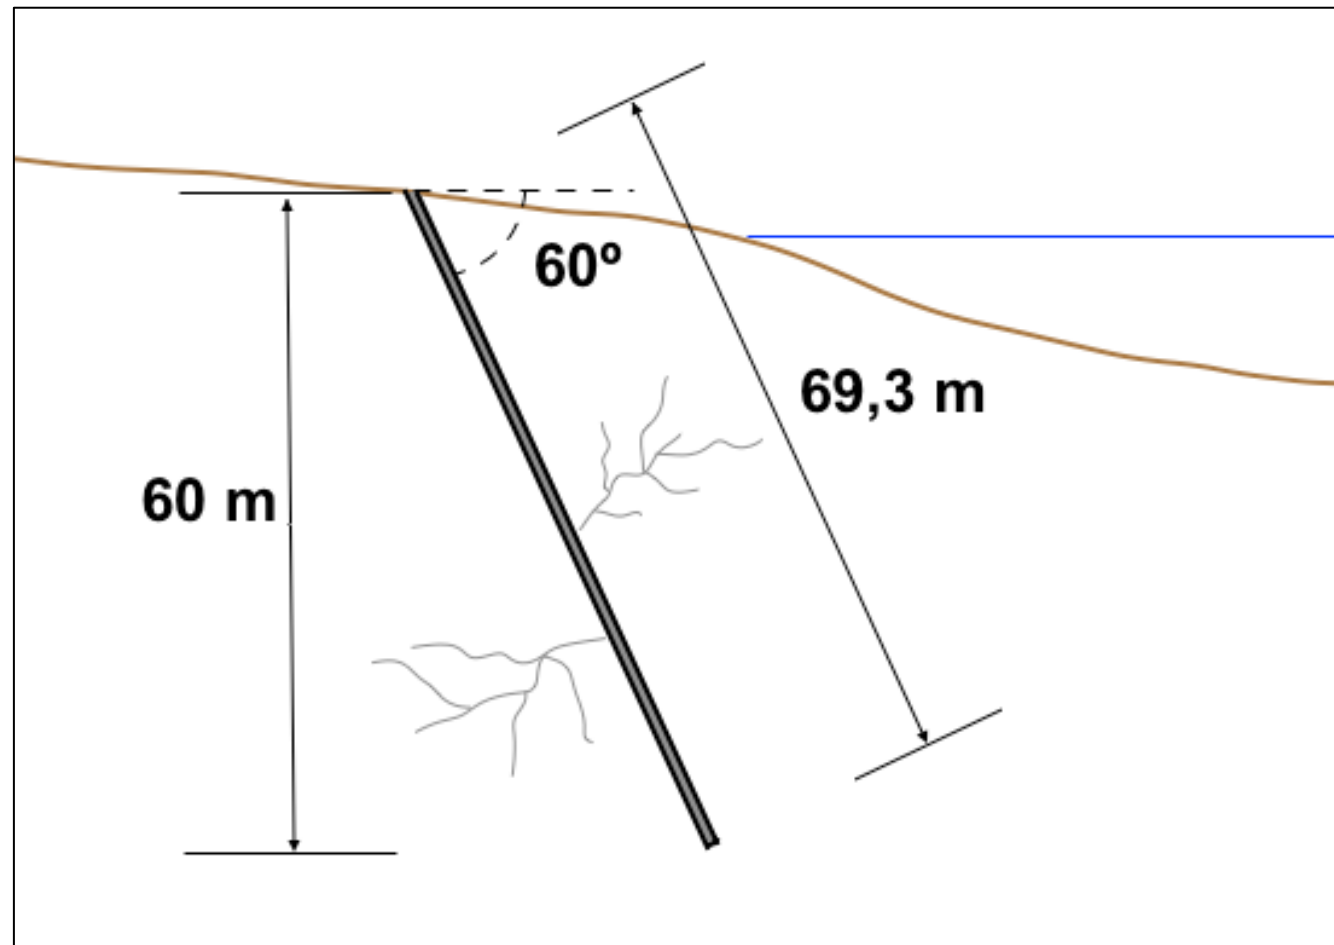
Perfil transversal de la pantalla. Fuente: Propia
